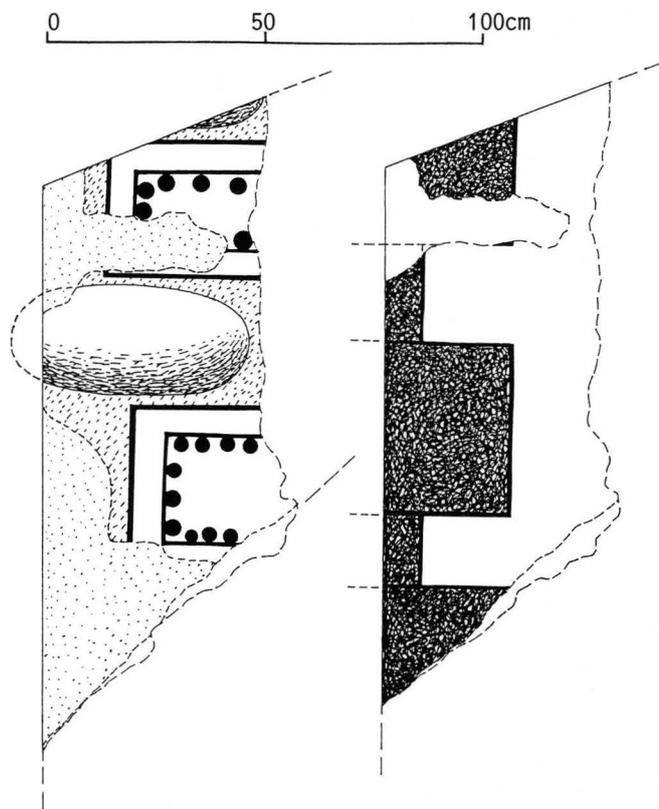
Malereireste an der ehemaligen Nordwestecke des Hauptgebäudes. Links: Umzeichnung der älteren Fassung, rechts: jüngere Fassung. – Zeichnung: St. Tramèr.
